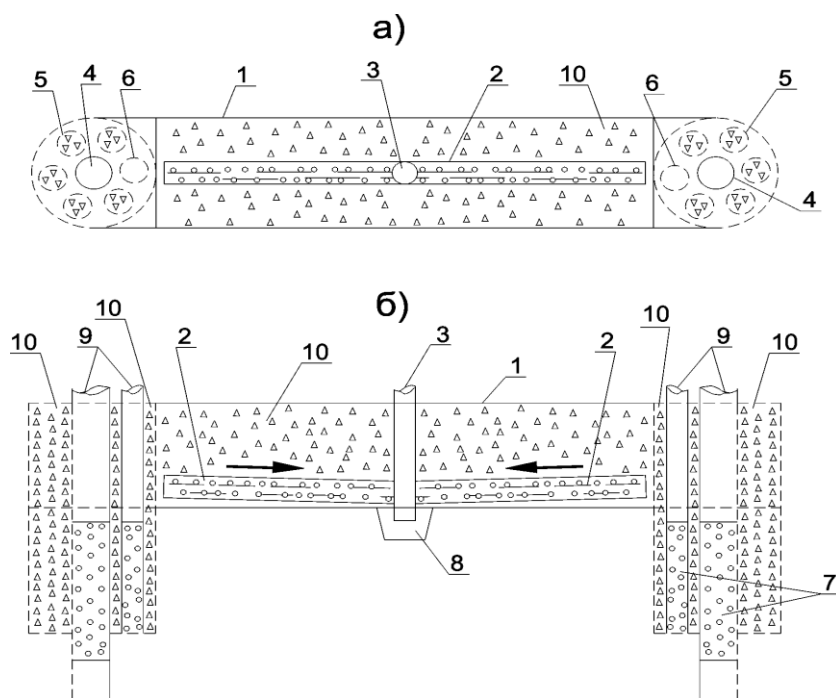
Установка ОГУ по перехвату загрязняющих веществ совмещенным горизонтальным и вертикальным дренажом: 1 – горизонтальная горная выработка с дренажной трубой, заполненная дресвой и щебнем; 2 – труба дренажная перфорированная; 3 – выводная труба; 4 – эксплуатационные скважины, оборудованные погружными насосами; 5 – скважины с дресвяно-щебнистой засыпкой; 6 – скважина-пьезометр для наблюдений; 7 – перфорированные интервалы эксплуатационных и наблюдательных скважин; 8 – сборник загрязненных вод; 9 – обсадные трубы; 10 – дресвяно-щебнистый наполнитель площадей
